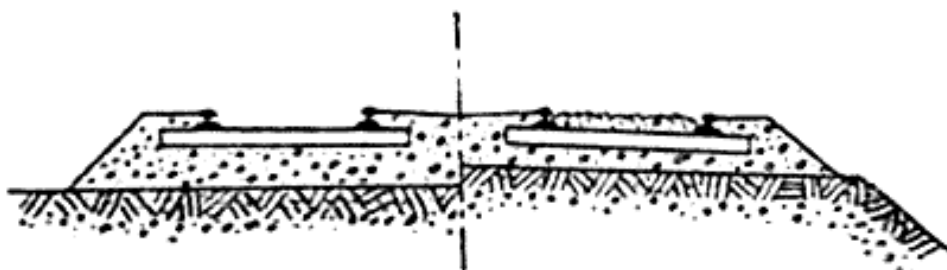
22 Secciones transversales de vía, con durmientes al descubierto, en el primer caso, y cubiertas por el balasto en el segundo.²⁵
